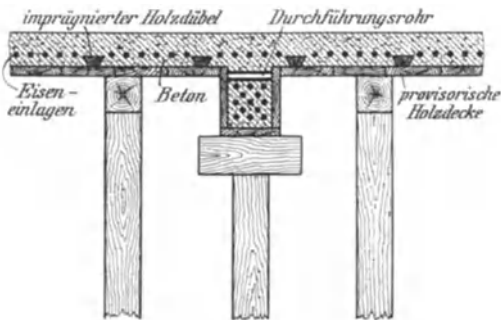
Querschnitt durch eine Eisenbetondecke mit eingelegten Dübeln und Durchführungsrohren.
